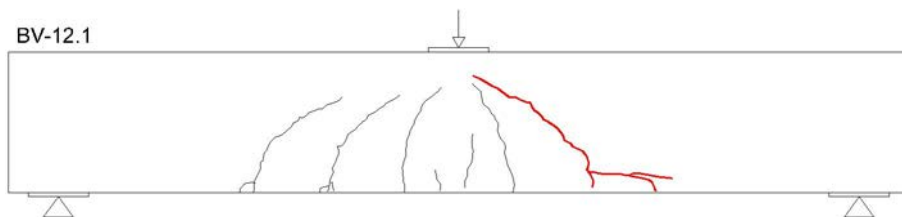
Rissbild BV-12.1, Einzelstäbe mit Endhaken
